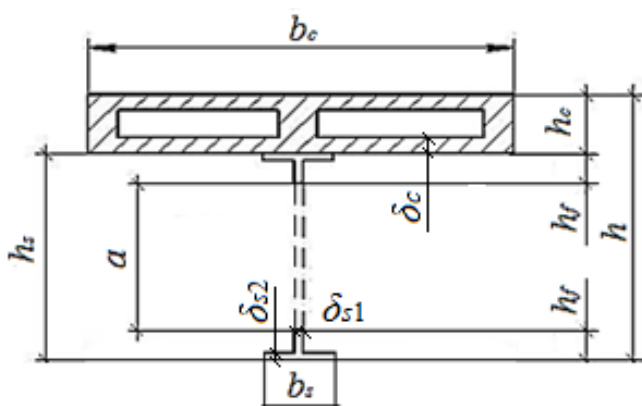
Поперечний переріз фрагмента прогонової будови.
